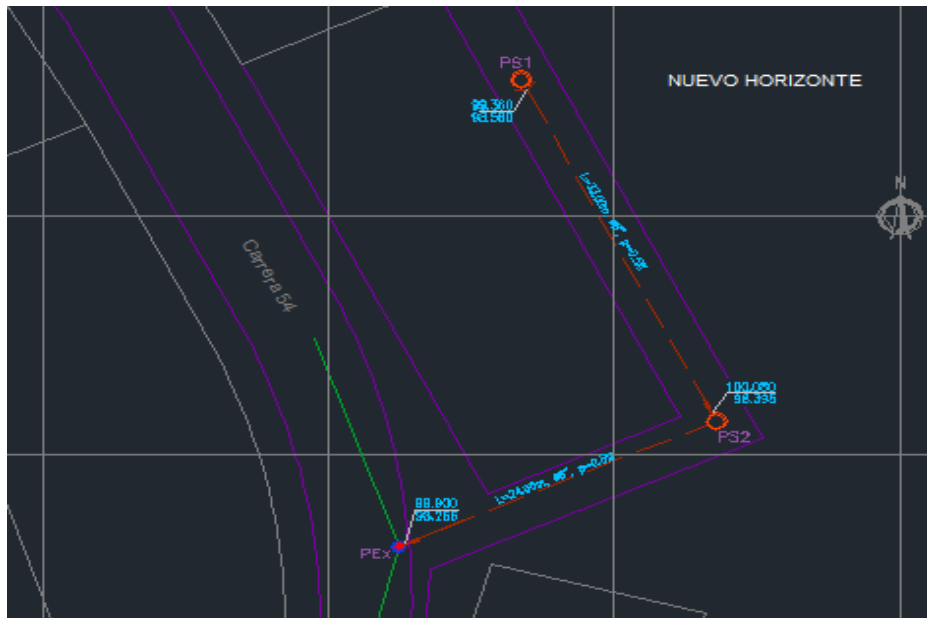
Captura plano Autocad vista en planta del diseño constructivo, Barrio Nuevo Horizonte
